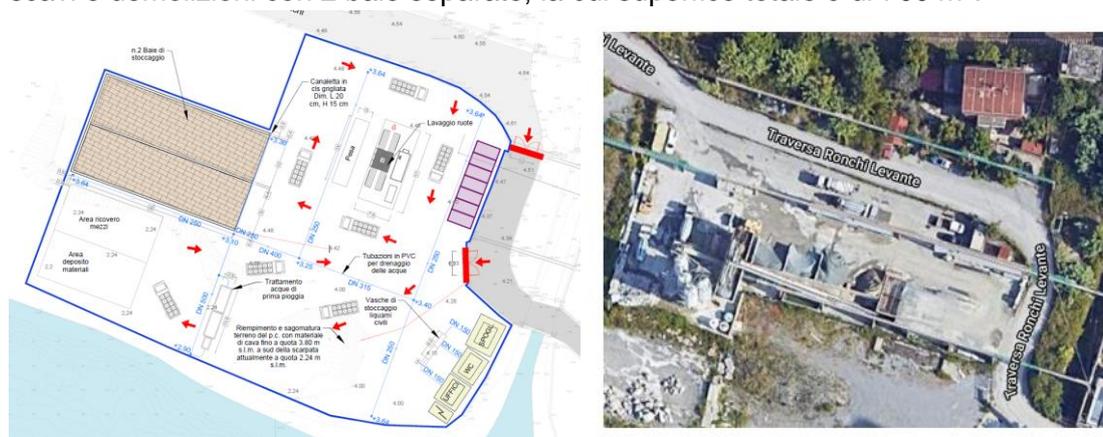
area di cantiere C4 – Layout di cantiere ed inquadramento territoriale
